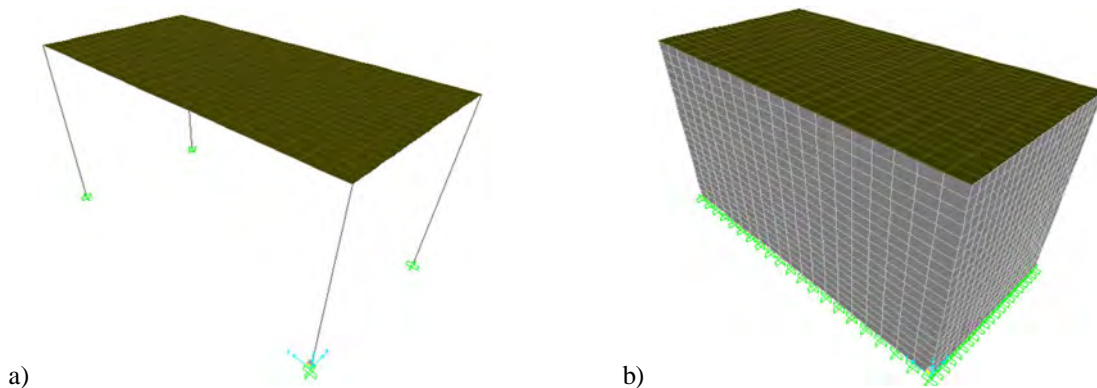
Panel aislado apoyado sobre: a) vigas y b) muros.
